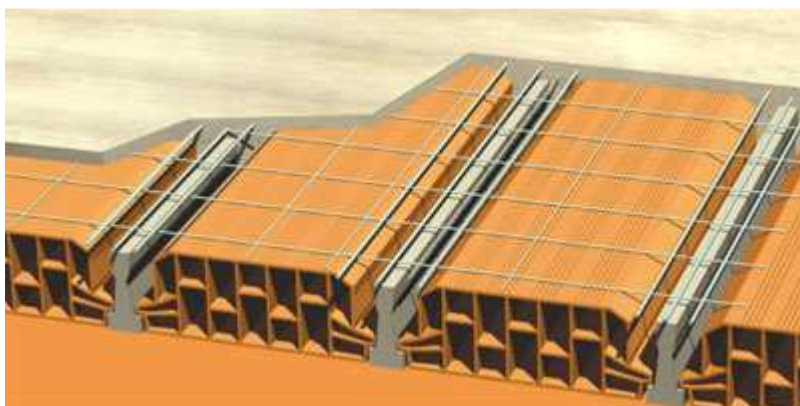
Forjado unidireccional con vigueta autoportante de hormigón pretensado.
